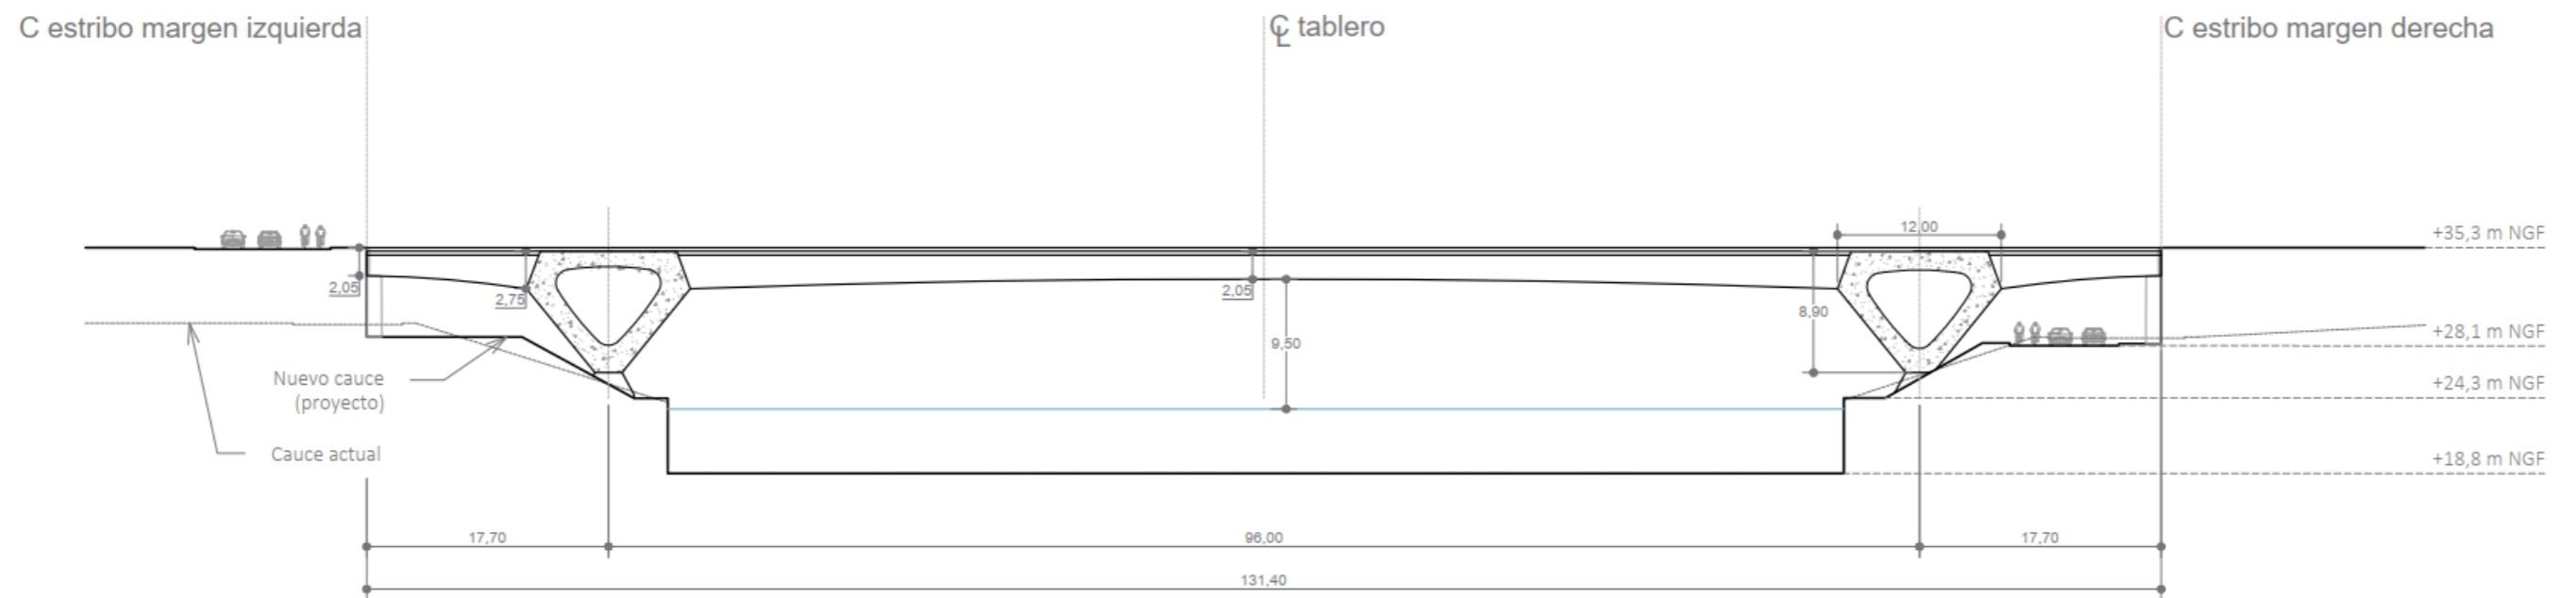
Sección longitudinal alternativa 1 puente viga (fuente: elaboración propia)
